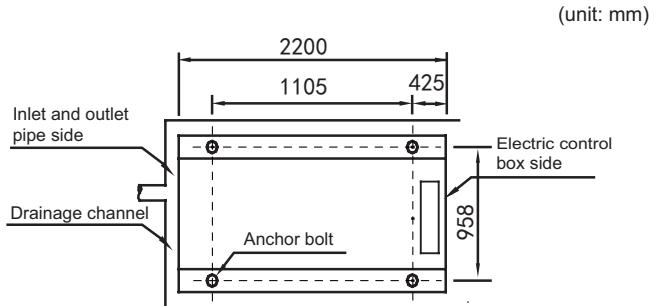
Vista dall'alto dello schema delle dimensioni di installazione dell'unità KEM-60 DNS3
